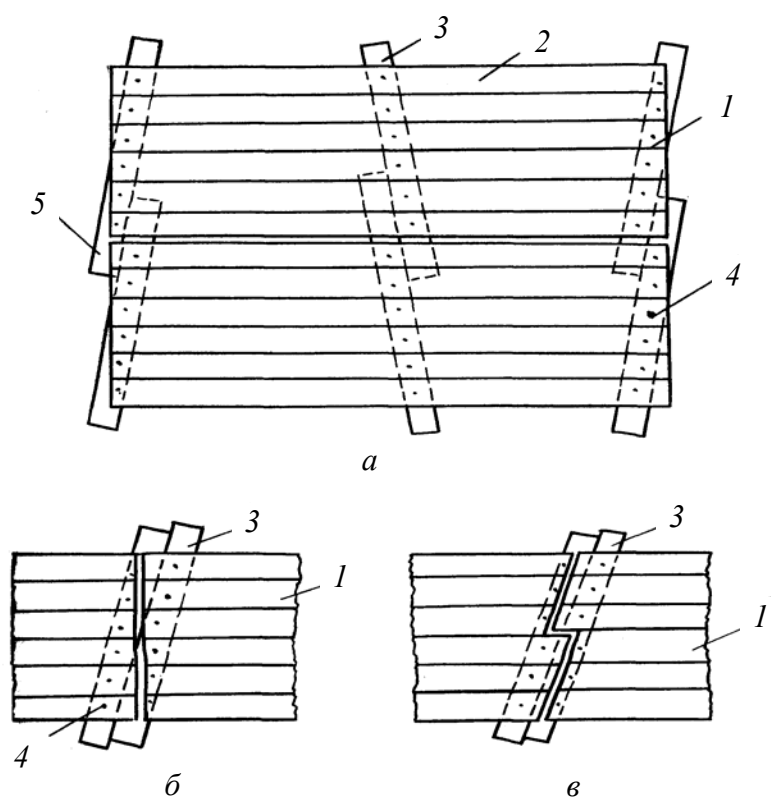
Универсальное сборно-разборное щитовое покрытие:
